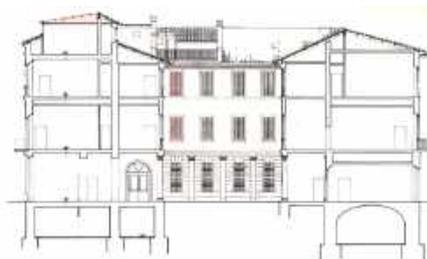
Sezione sud-est, progetto di restauro (rielaborazione)
